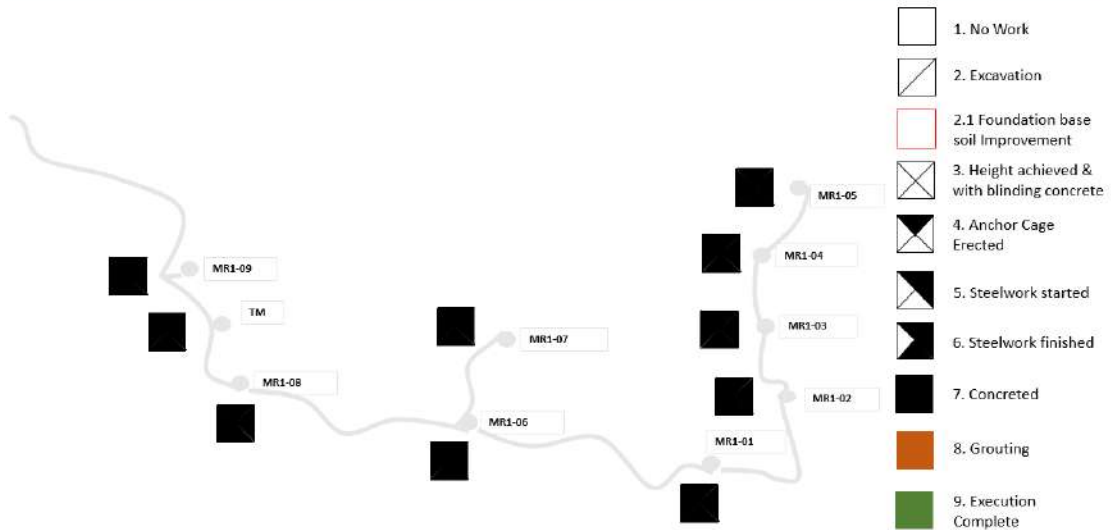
Estado y plano de obras ejecutadas a fin de mes.
